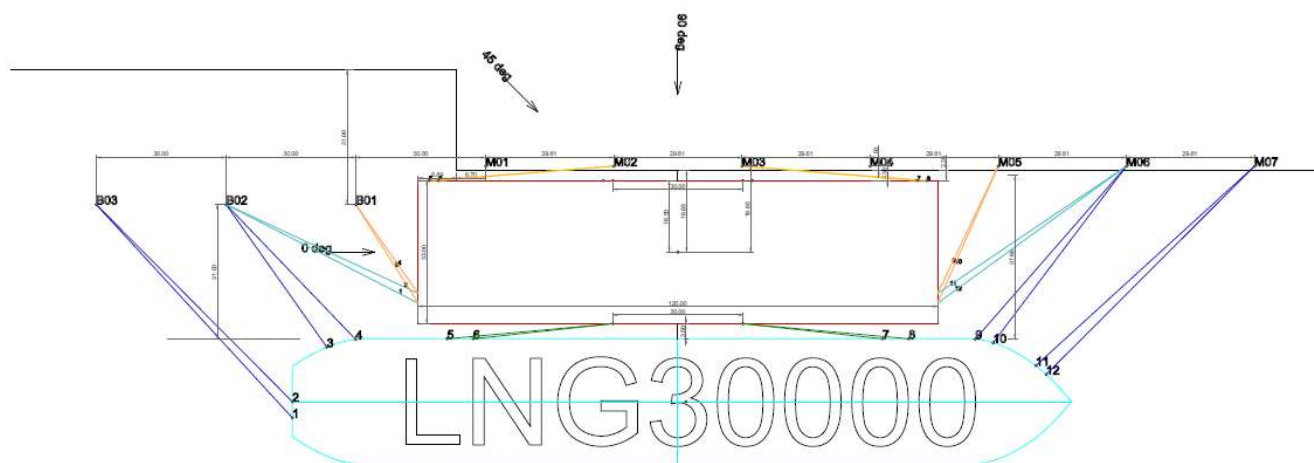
Layout sistema ormeggio FSRU e LNG 30000 m3
